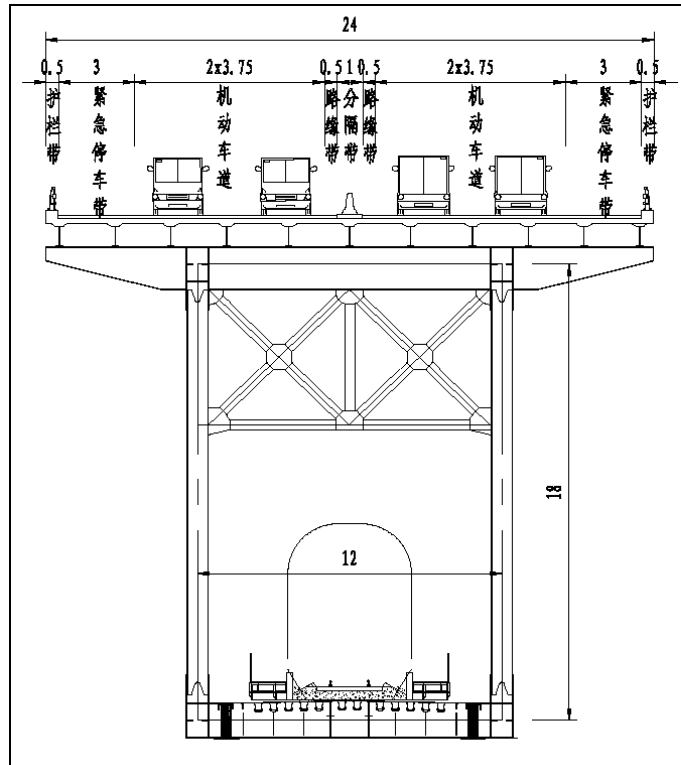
续钢桁梁方案标准横断面示意图（单位：m）
